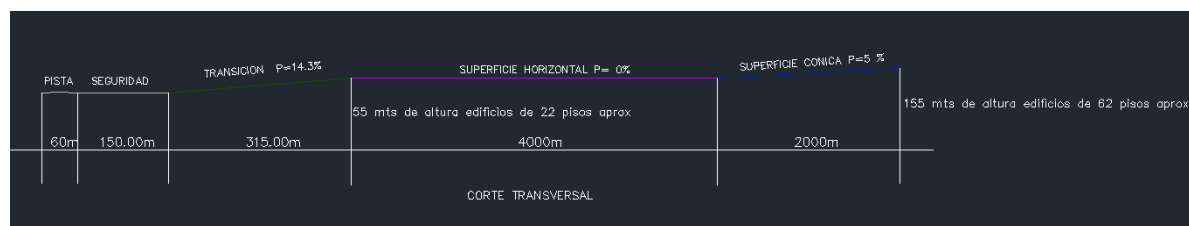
Detalle de las dimensiones para la superficie cónica.
